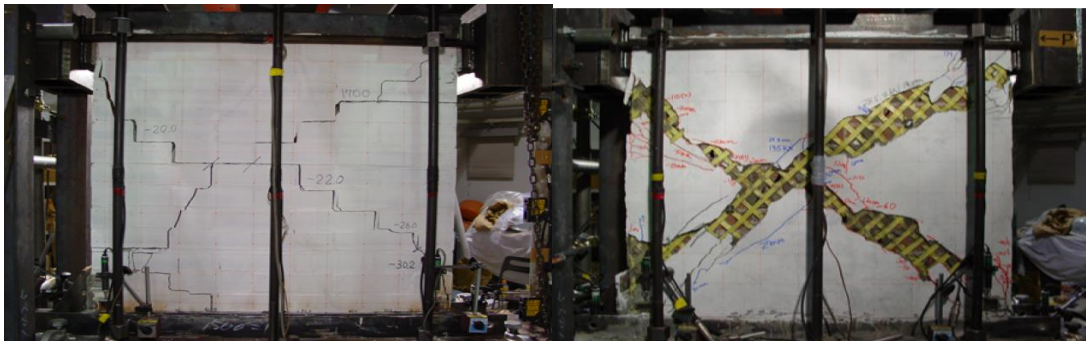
Fallas típicas de un muro de mampostería no reforzada; Imagen 3.2.3-2. Fallas típicas de muro reforzado con bandas de polímero PP Band. Fuente: MAYORCA, P., NAVARATNARAJ, S., y MEGURO, K. *Report on the state-of-the-art in the seismic retrofitting of unreinforced masonry houses by PP-Band meshes*. Tokyo: International Center for Urban Safety Engineering. Institute of Industrial Science. University of Tokyo, 2006.
